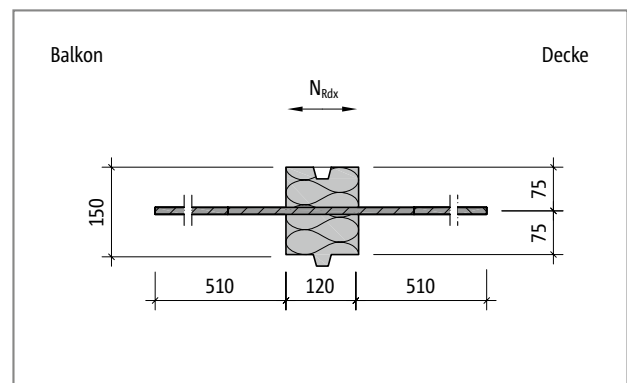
Schöck Isokorb® XT Typ HP-NN2: Produktgrundriss
